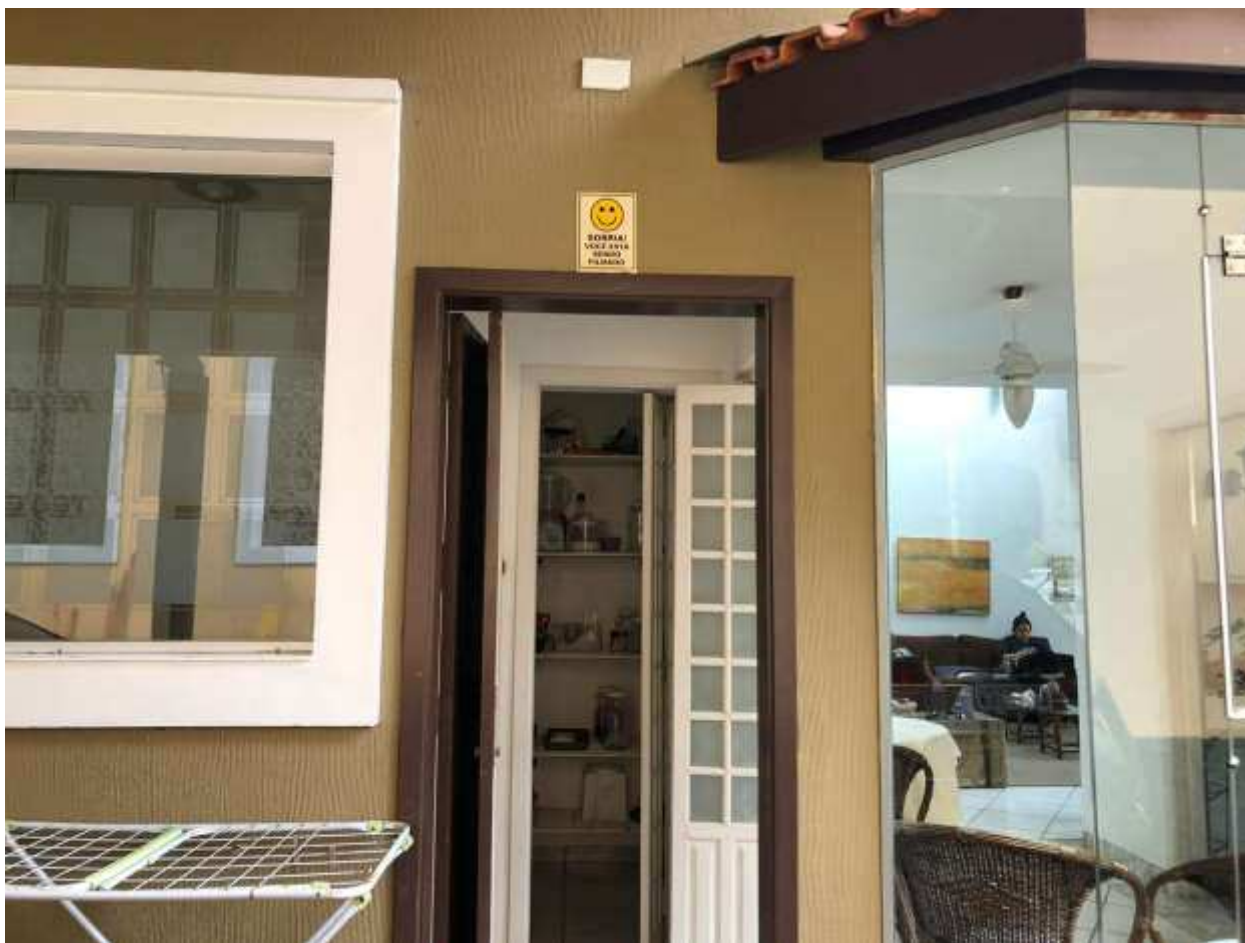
VISTA GERAL DO ACESSO DA ÁREA EXTERNA PARA O INTERIOR DO IMÓVEL.
